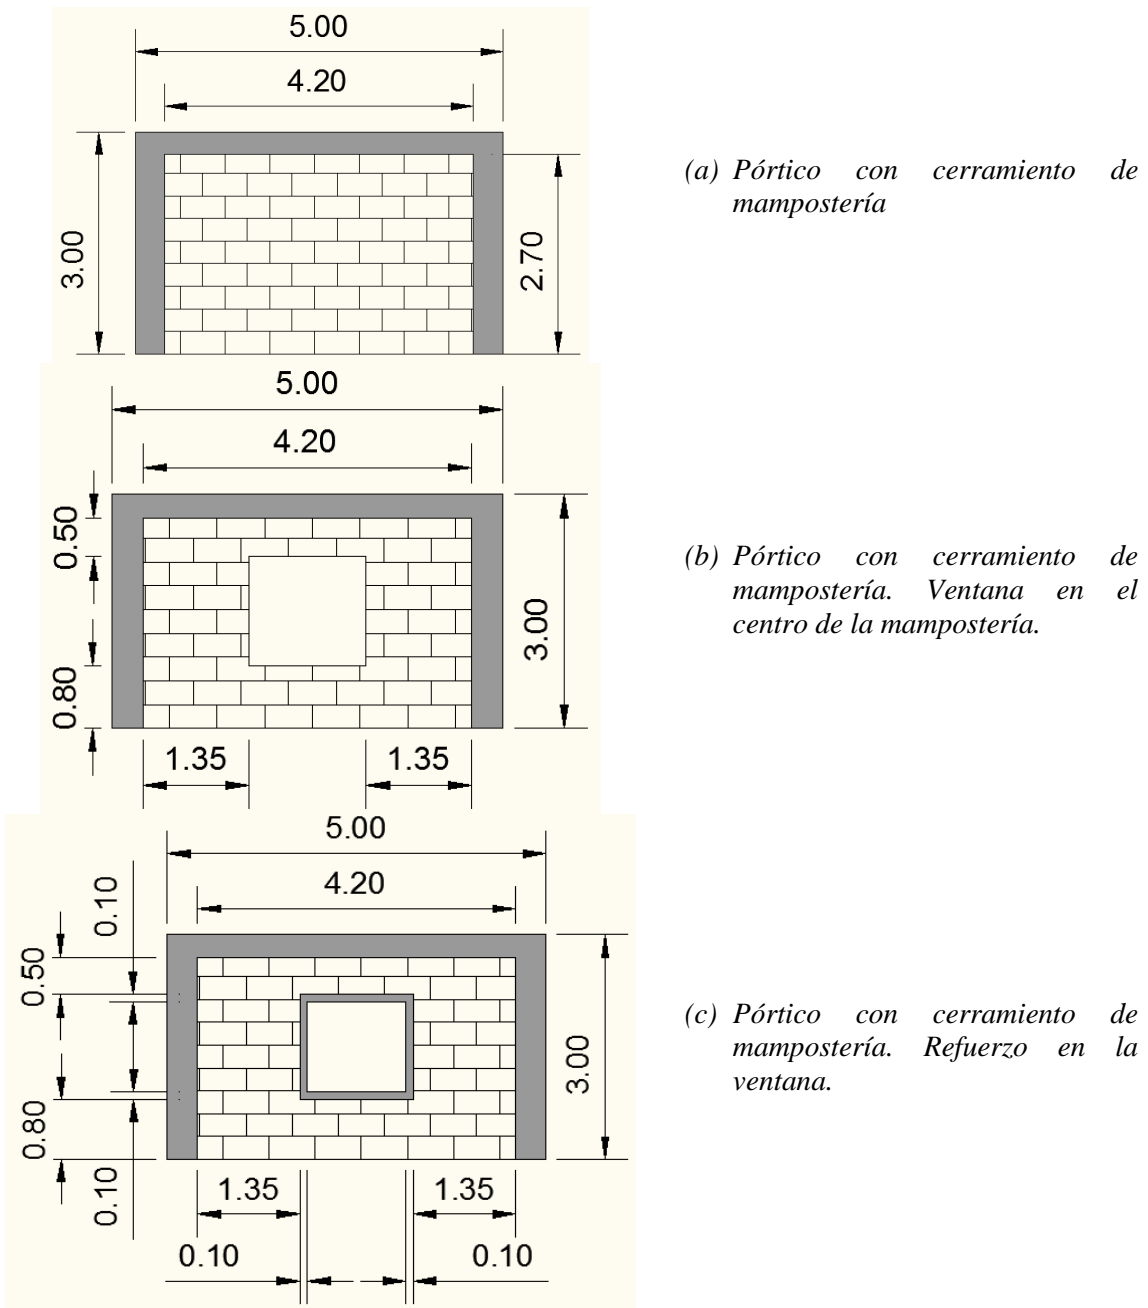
Geometrías de las diferentes configuraciones de la mampostería
